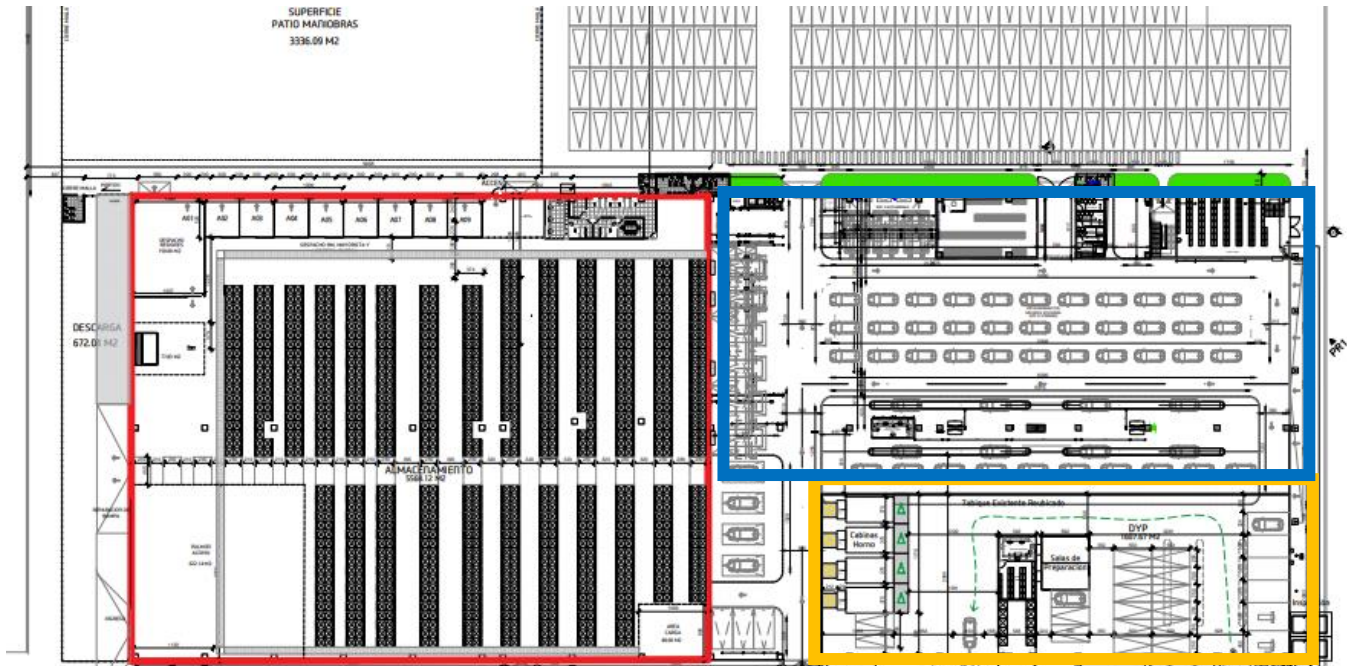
"Layout CD, Preentrega y Taller DyP Automotores Gildemeister Lonquén". Fuente Propia.
